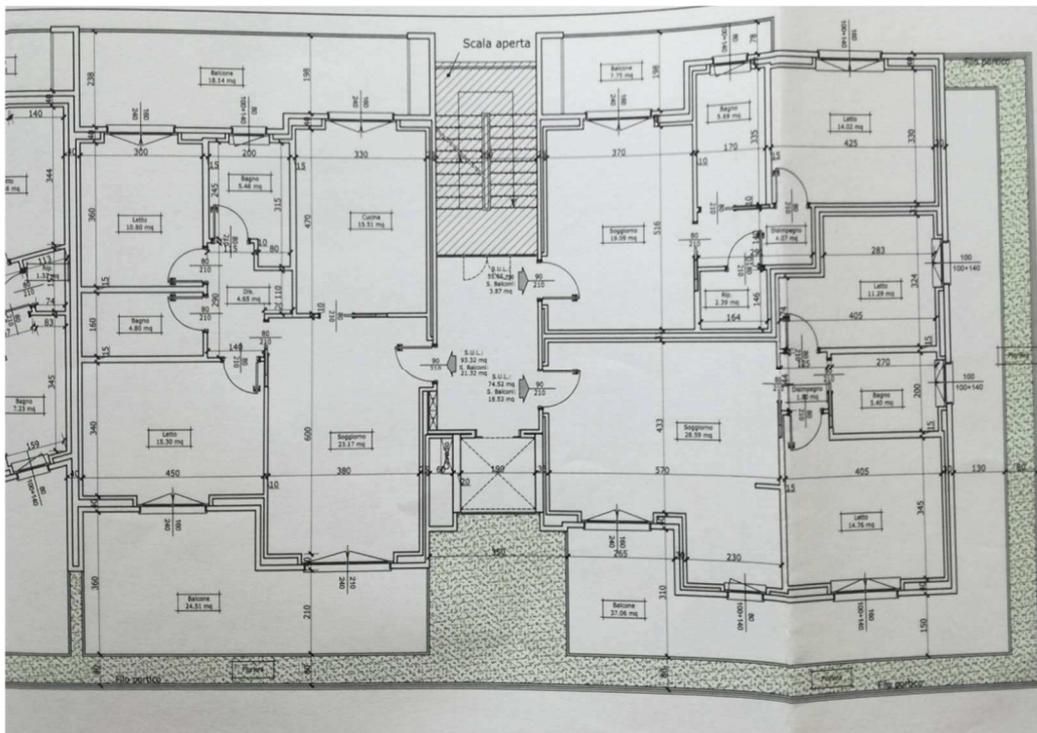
Estratto pianta piano tipo edificio residenziale in piazza Campidoglio
